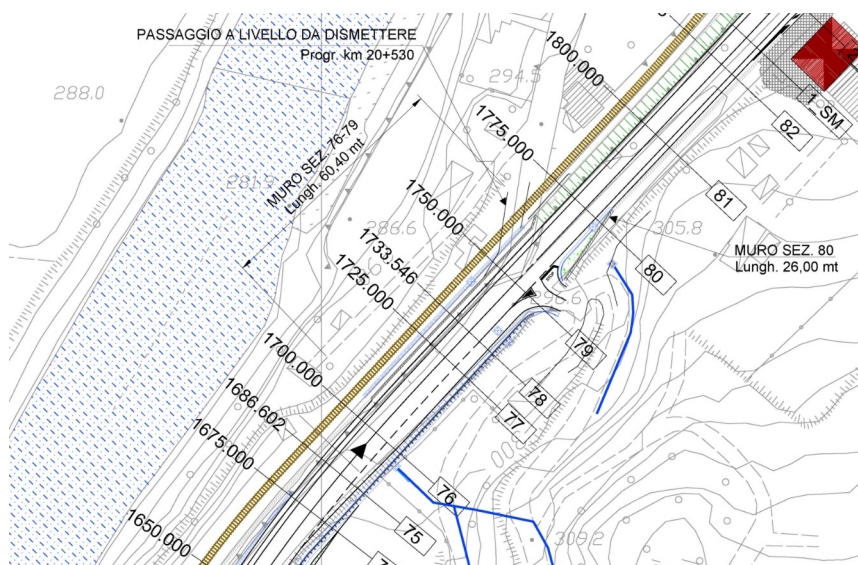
Stralcio planimetrico progetto variante SRT 71: tratto tra le progressive 76 e 79
